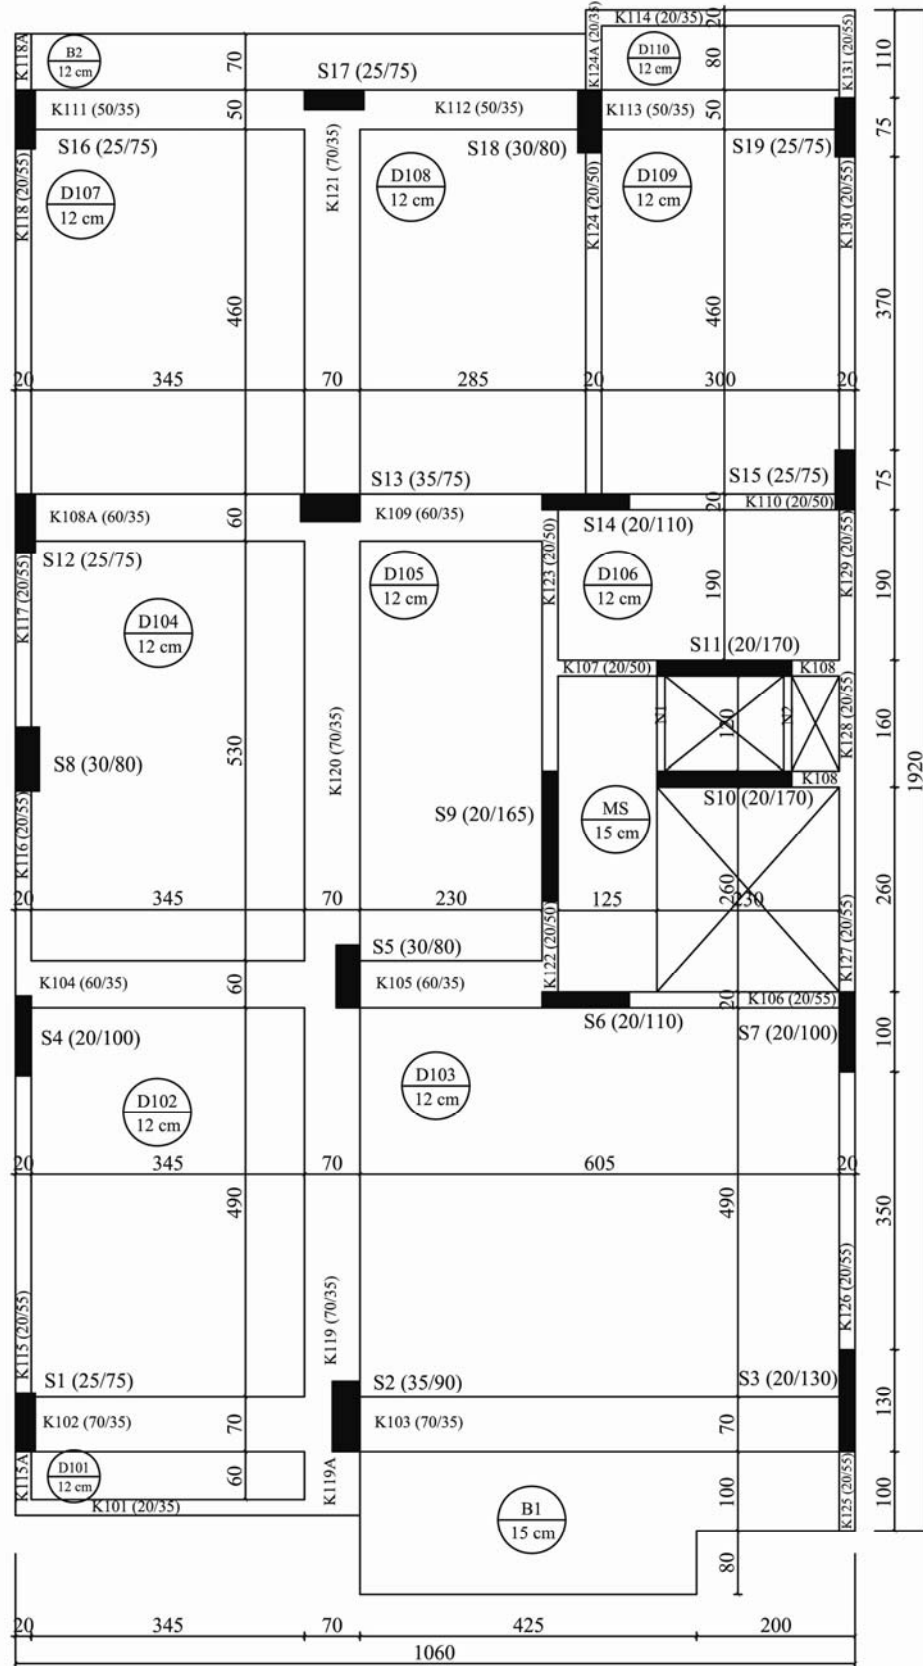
B7\_5'in 1. kat kalıp planı
